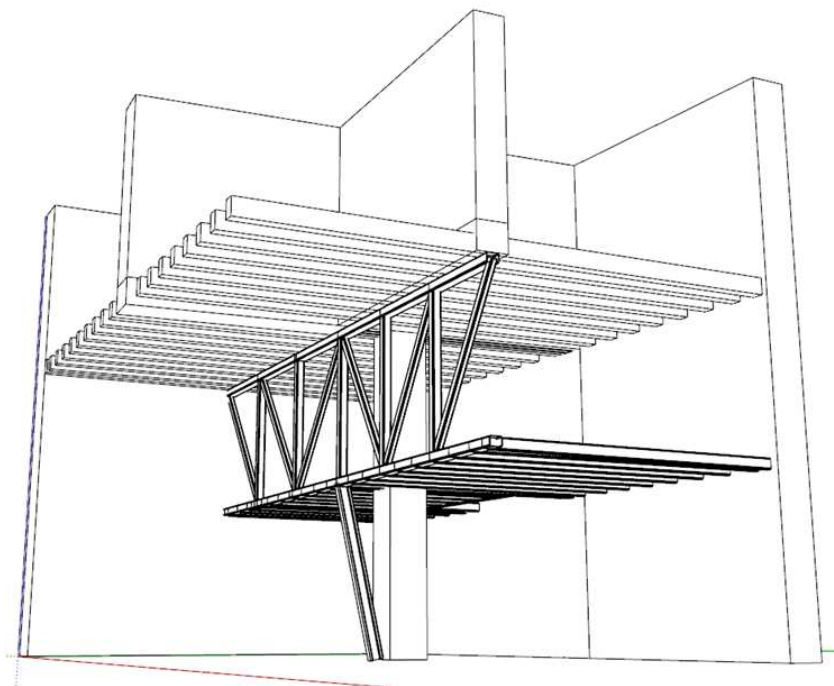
Esquema gráfico de la estructura de la entreplanta de la cochera y planta alta
